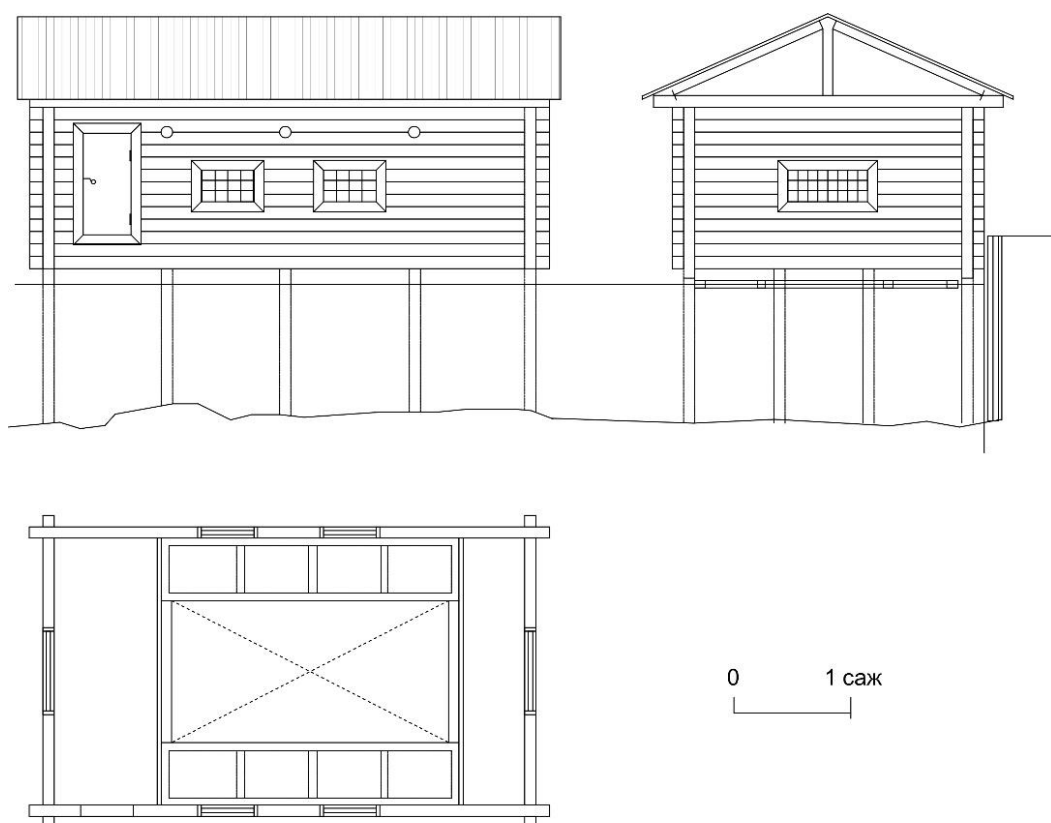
Усадьба И.И. Худякова на берегу р. Уводи в г. Иваново-Вознесенск. 1874 г. Мытилка. Фронтальный и боковой фасад. План [8]
